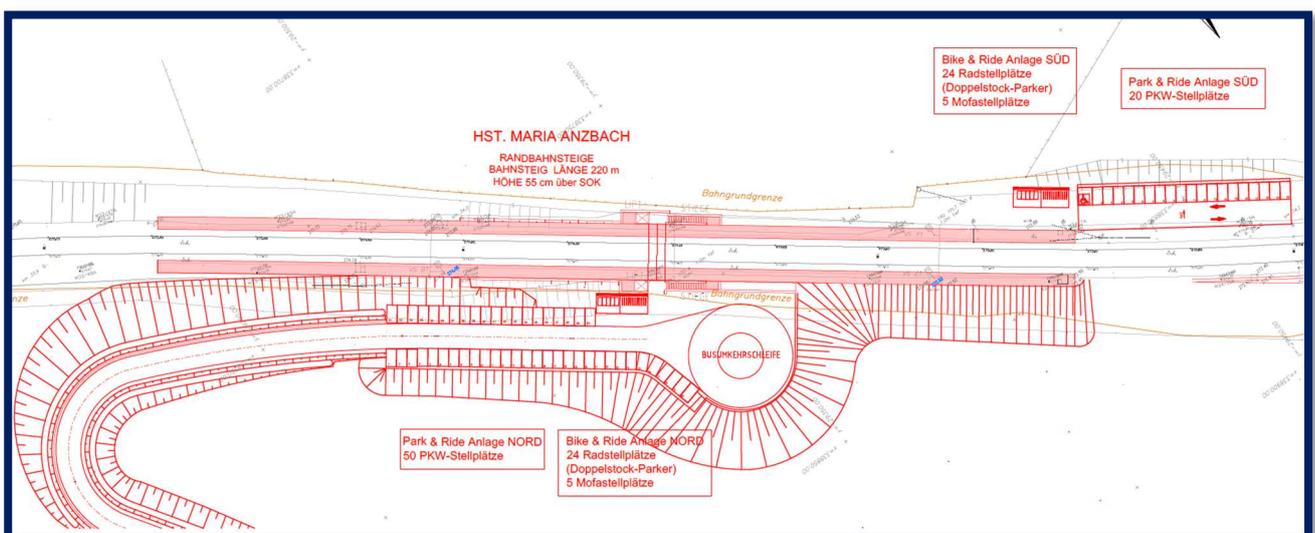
Plandarstellung der Park & Ride Anlage der neuen Haltestelle in Maria Anzbach
